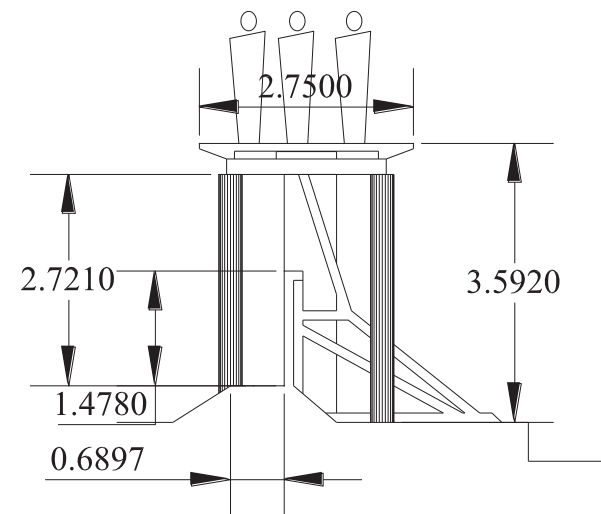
seccion transversal del puente. Elaboración, Andre Aguilar.
